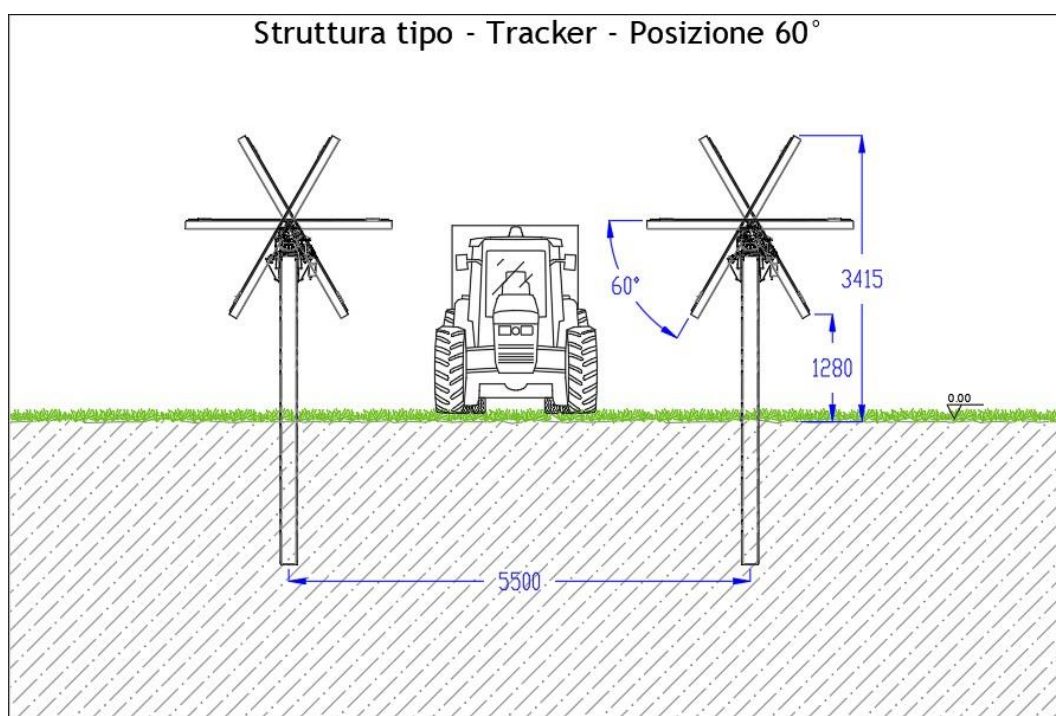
Tipico struttura di supporto – Vista posizione 60°
